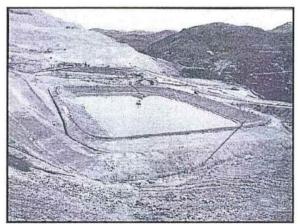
Bombeo de la vía hacia los canales de coronación de la Poza 18.
